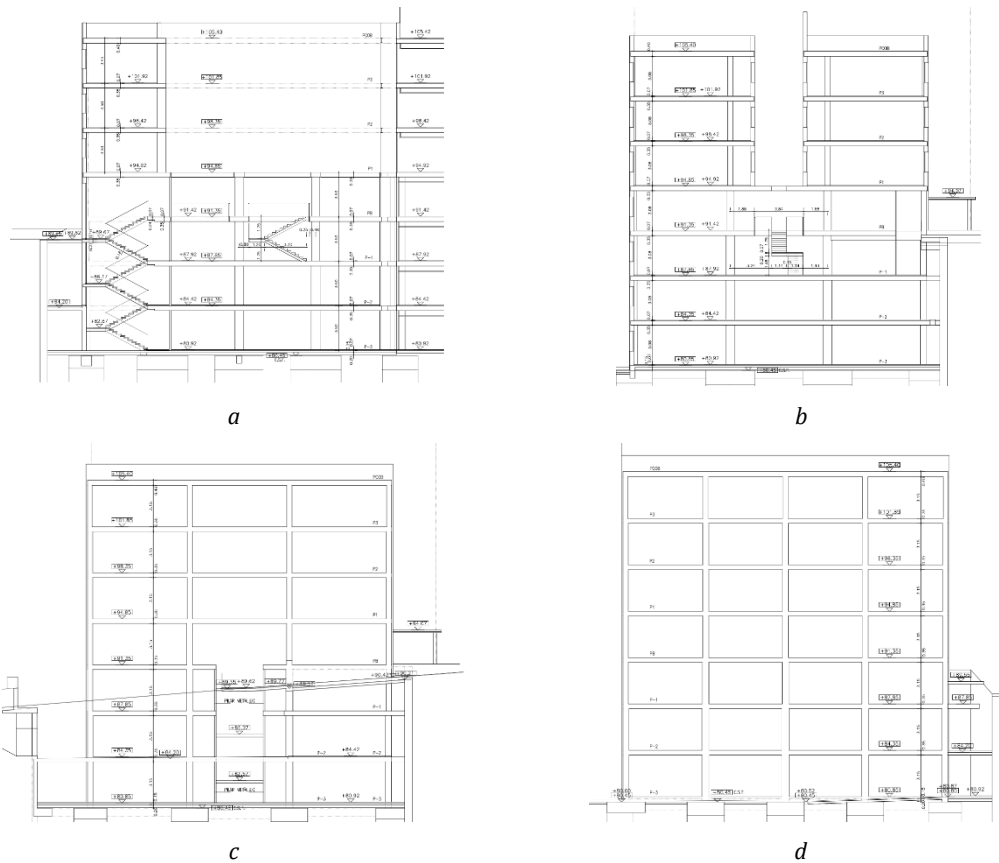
Detalles del edificio OMEGA (Barcelona), Secciones del alzado: a) Zona de gradas, b) Detalle interno, c) Fachada lateral, d) fachada frontal
